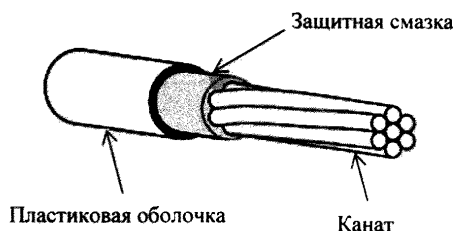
Конструкция арматурного элемента с канатной арматурой в защитной оболочке
